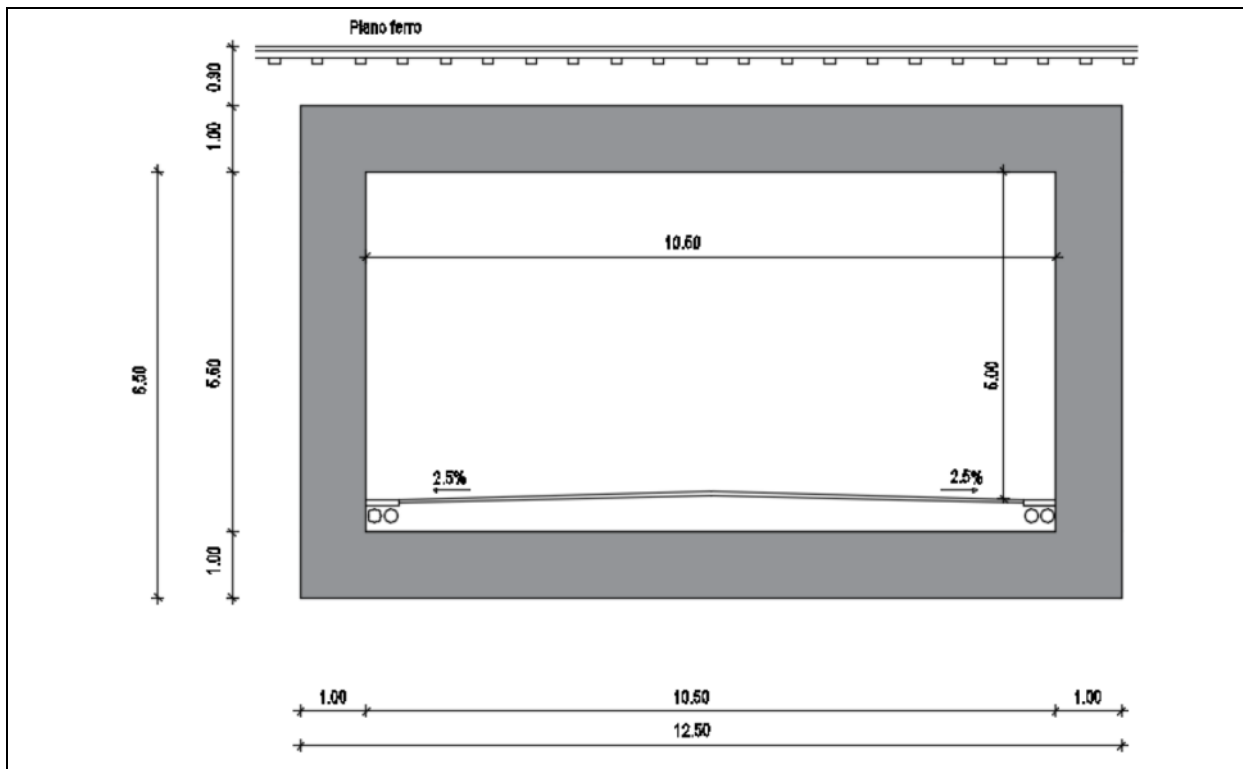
Sezione in asse attraversamento ferroviario al km 32+407.
